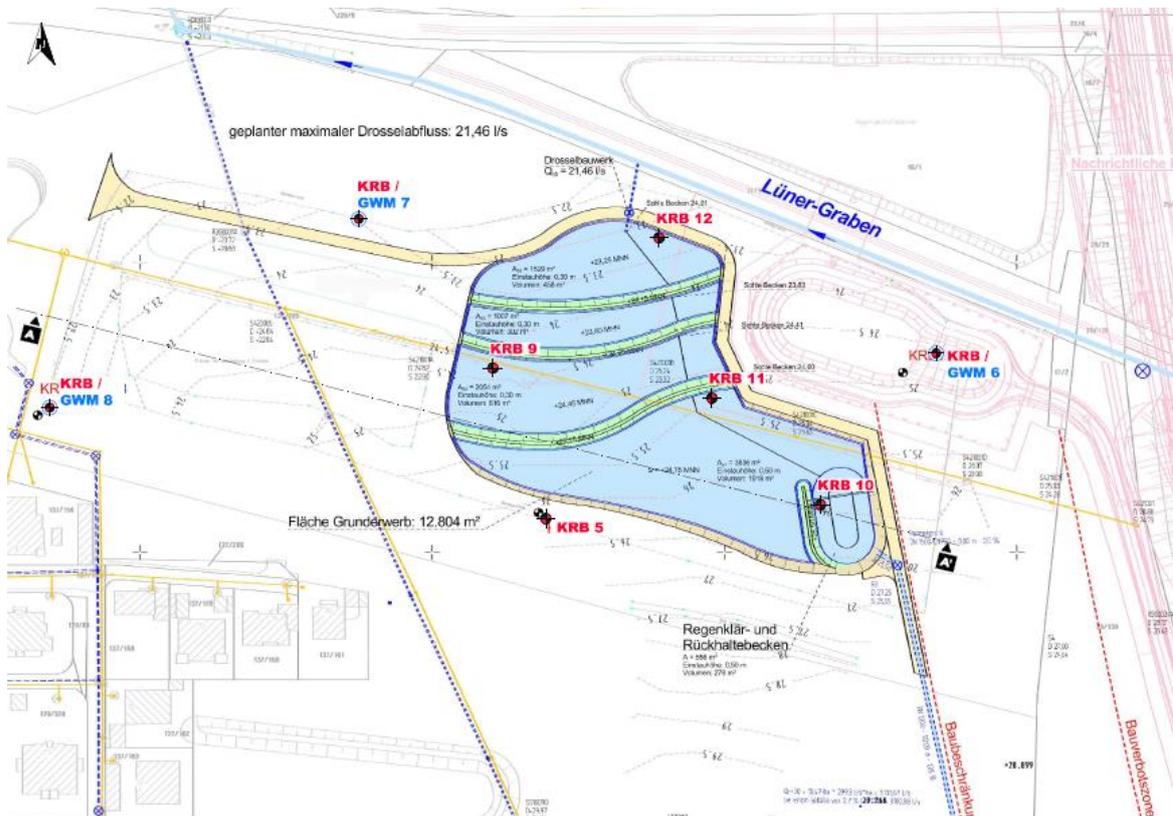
Regenklär- und Versickerungsbecken mit Darstellung der Standorte der Rahmkernelbohrungen und Grundwassermessstellen (Planverfasser: geo-log, 24.1.2017)
